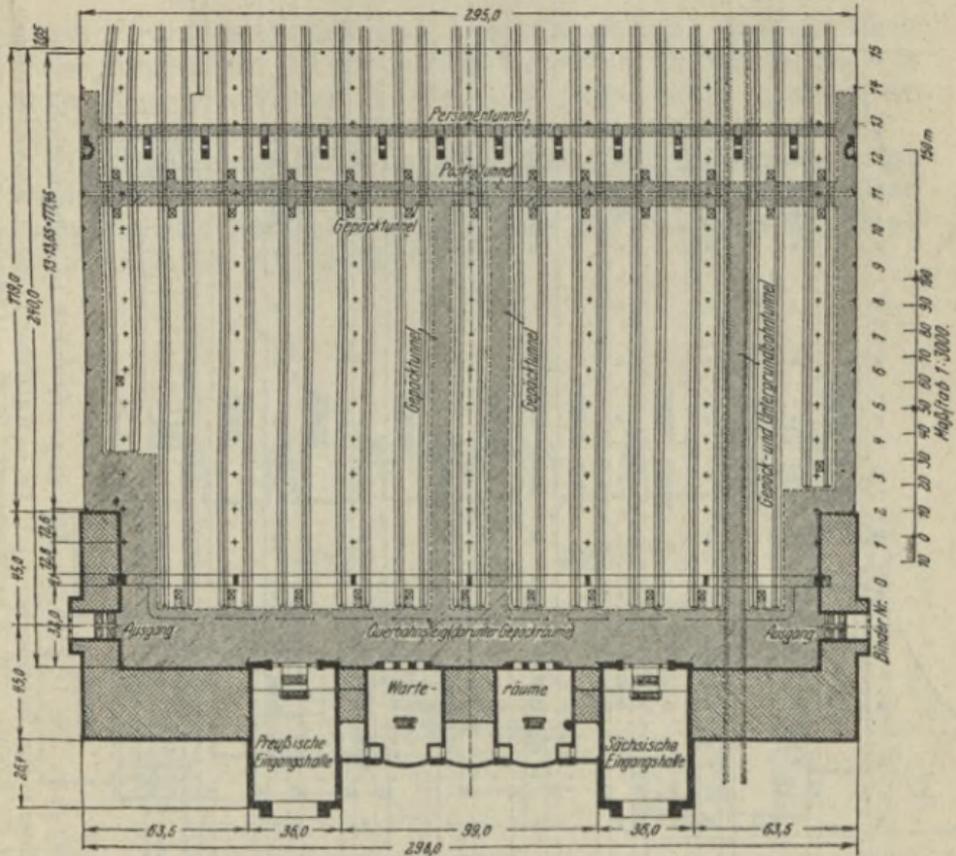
Übersicht Grundriß des Empfangsgebäudes und der Bahnsteiganlage Leipzig-Hauptbahnhof. M. rd. 1 : 4200.
